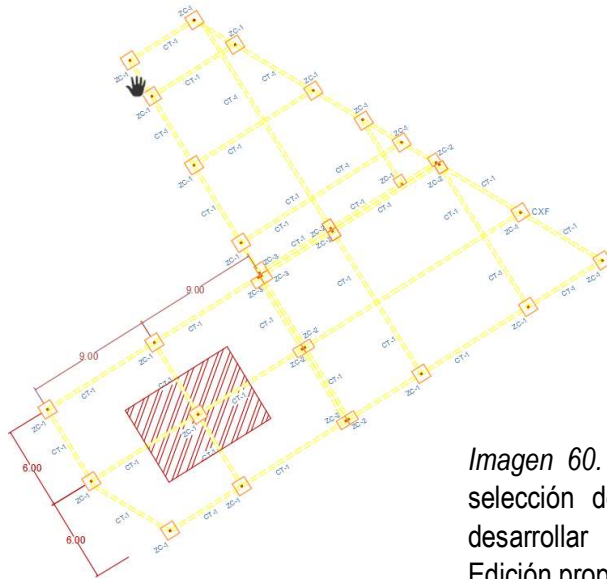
Croquis de selección de zapata a desarrollar [Ilustración]. Edición propia
